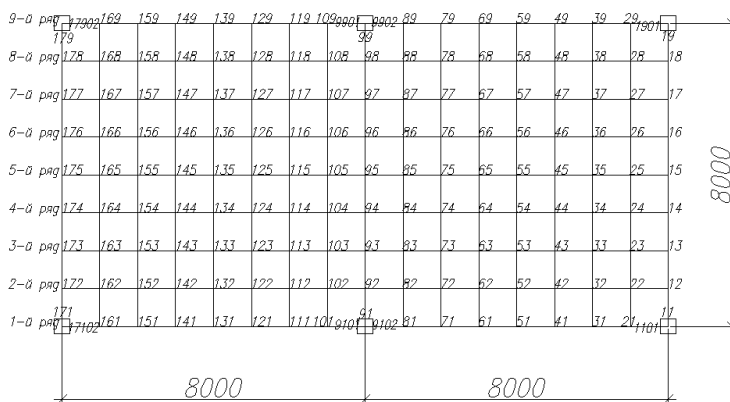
Номера точек при геодезической съемке фрагмента перекрытия
